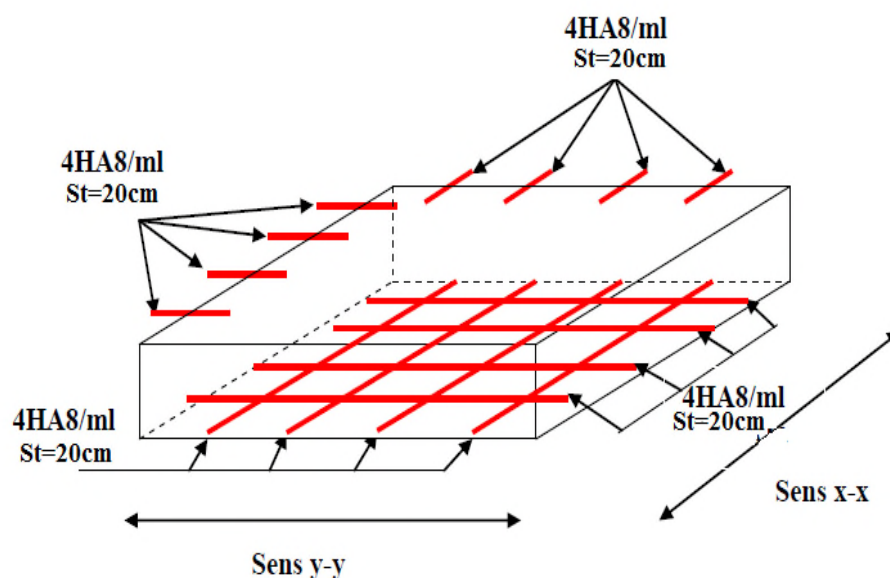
Schéma de ferrailage de la dalle pleine au-dessous de l'ascenseur.
